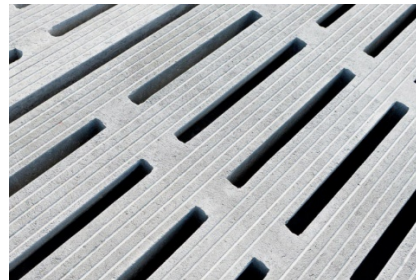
Photo de plancher de béton à claire-voie (ou caillebotis)
